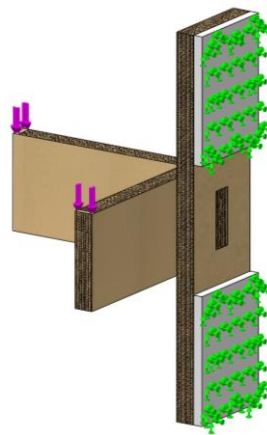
Configuración ensayo de carga estática sobre unión A-HHV || Fuente: Elaboración propia
